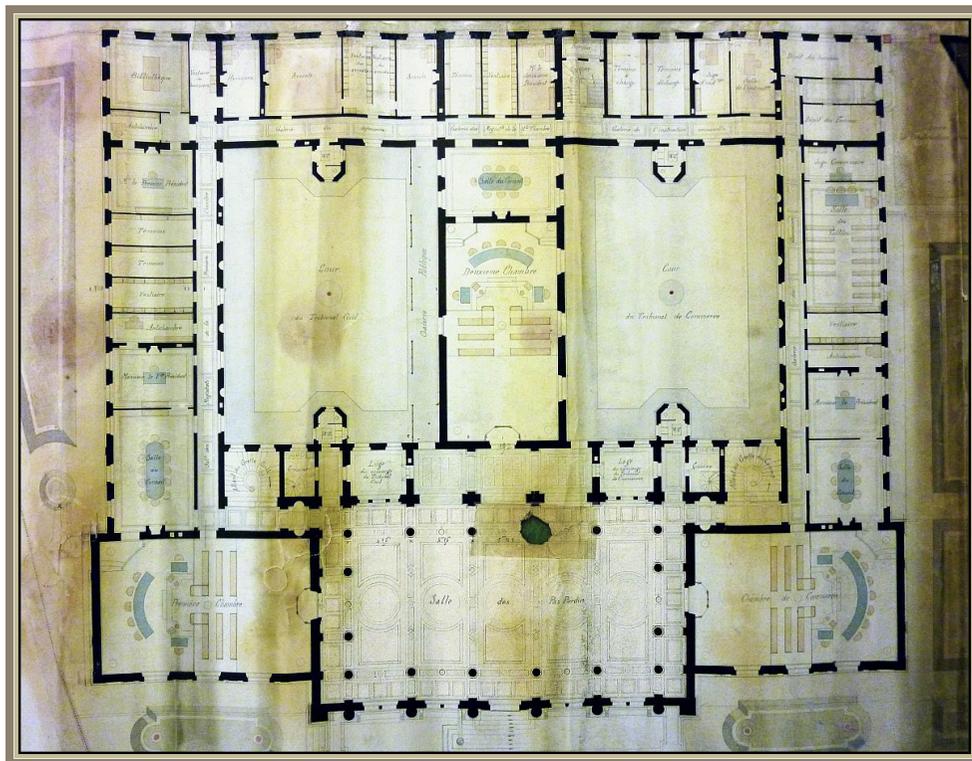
J. Bourdais, *Plan du rez-de-chaussée*, dossier de concours, janvier 1873
